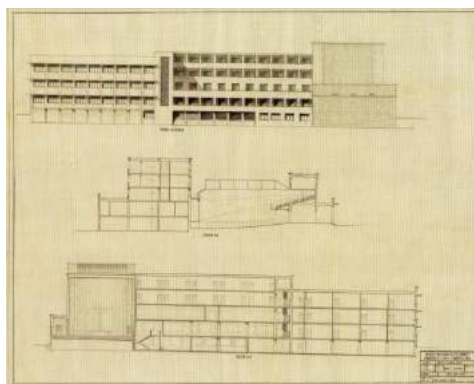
Alzados y Secciones del proyecto original Colegio San José.
